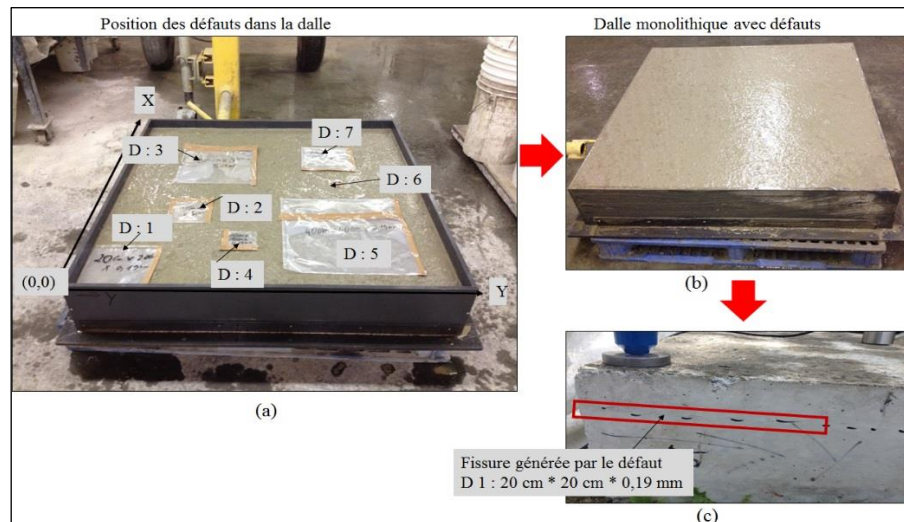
Dalle N° 5, (a) Mise en place des défauts (Tableau 9.1), (b) Remplissage du béton, (c) Dalle monolithique finale avec défauts.
